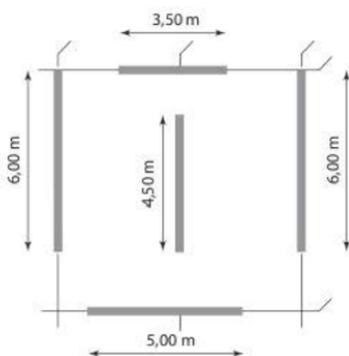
Vue en plan du bâtiment
